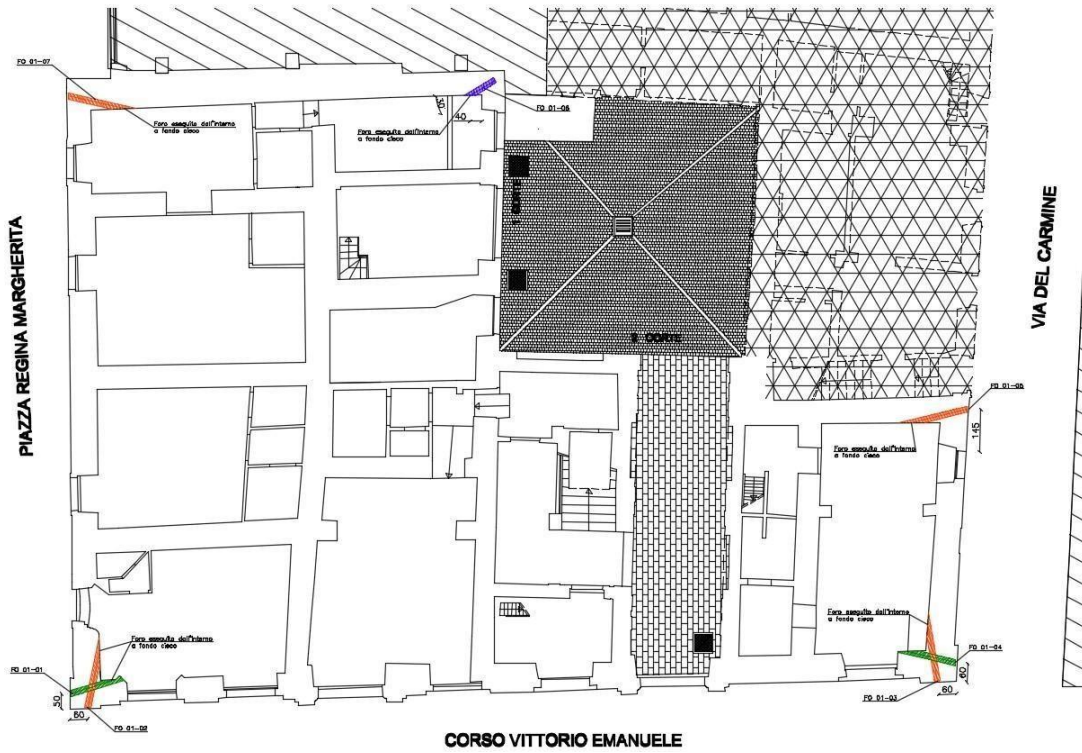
PIANTA PIANO TERRA - POSIZIONE SENSORI SUI MASCHI MURARI DEL 1° ORDINE MONITORATI
